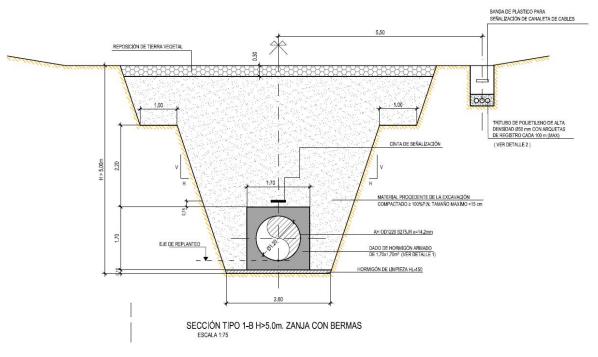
Sección tipo 1-B. Zanja simple con altura mayor de 5 metros
